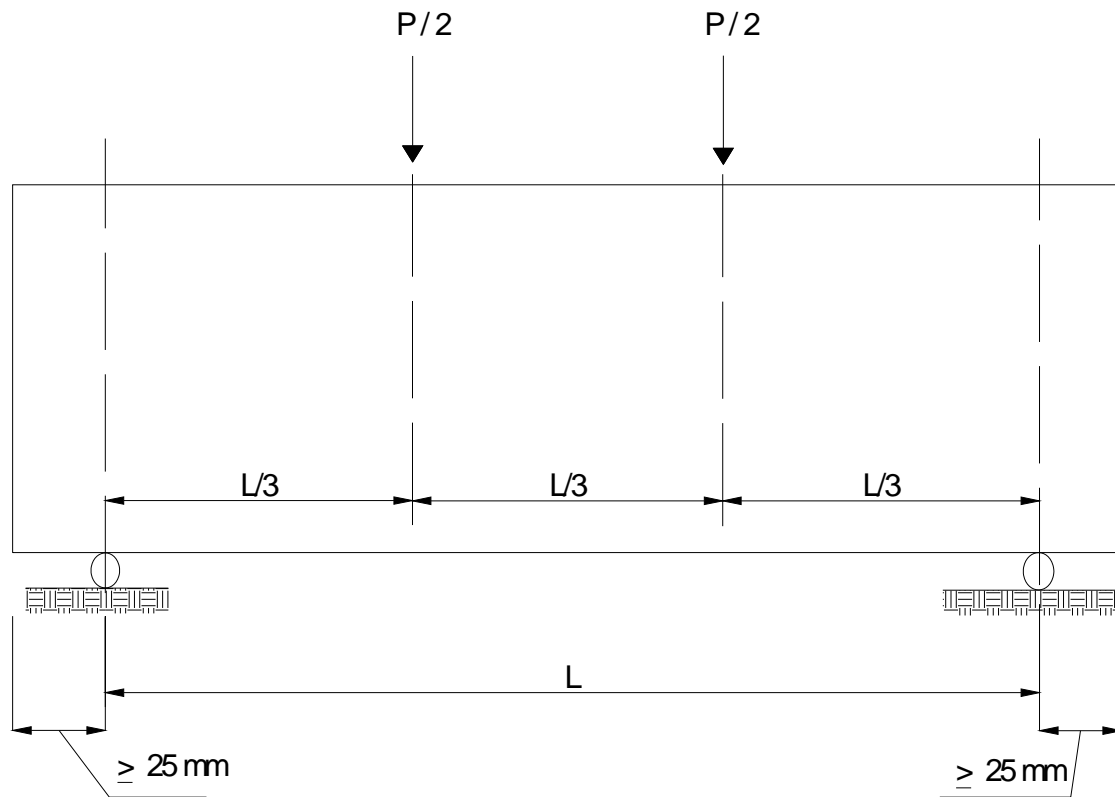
Ensaio de tração na flexão de concreto de cimento Portland (ABNT, 2010).
